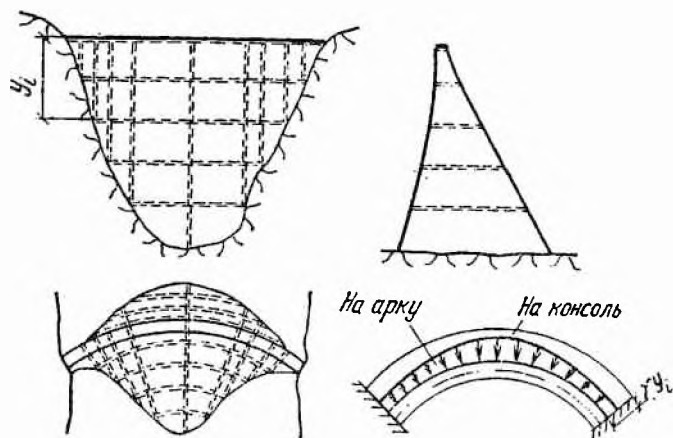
Схемы к расчету арочных плотин методом «арок — консолей»
